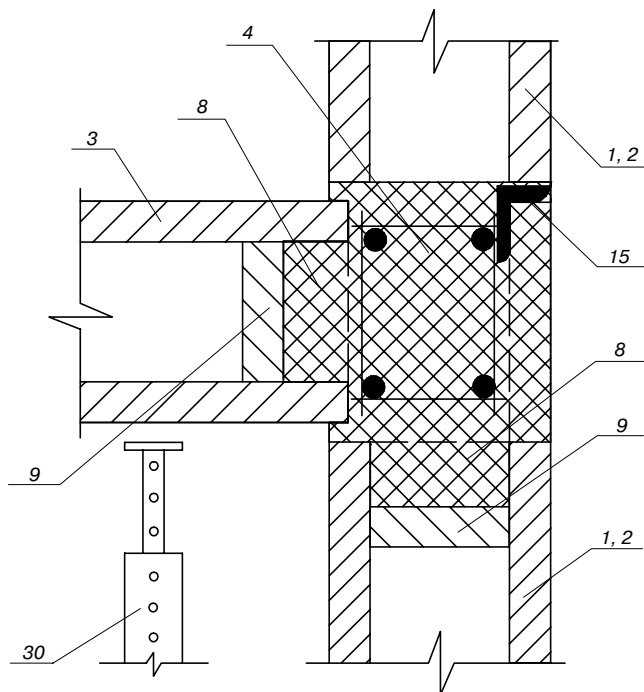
Вариант опирания плиты перекрытия в зоне стенового проема с монолитными шпонками
